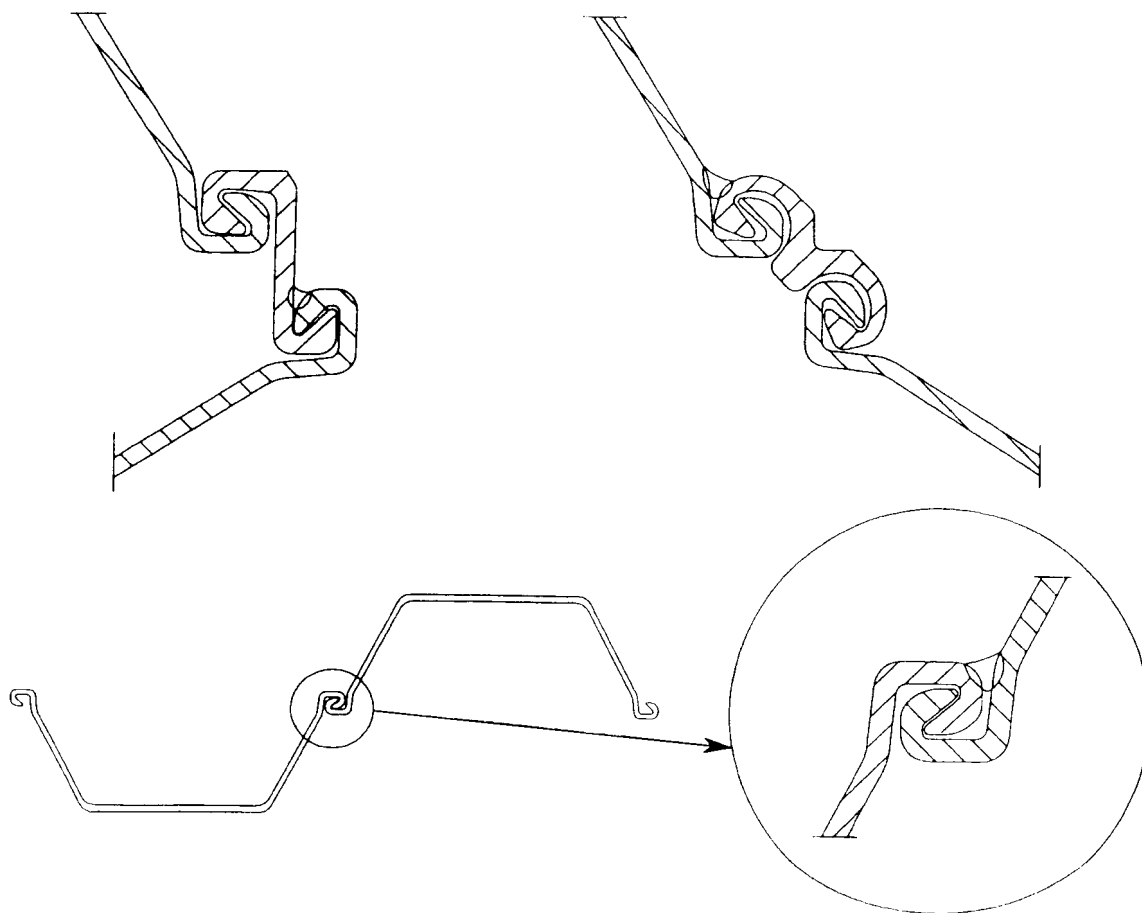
Soldadura en unión a tope de un junta
